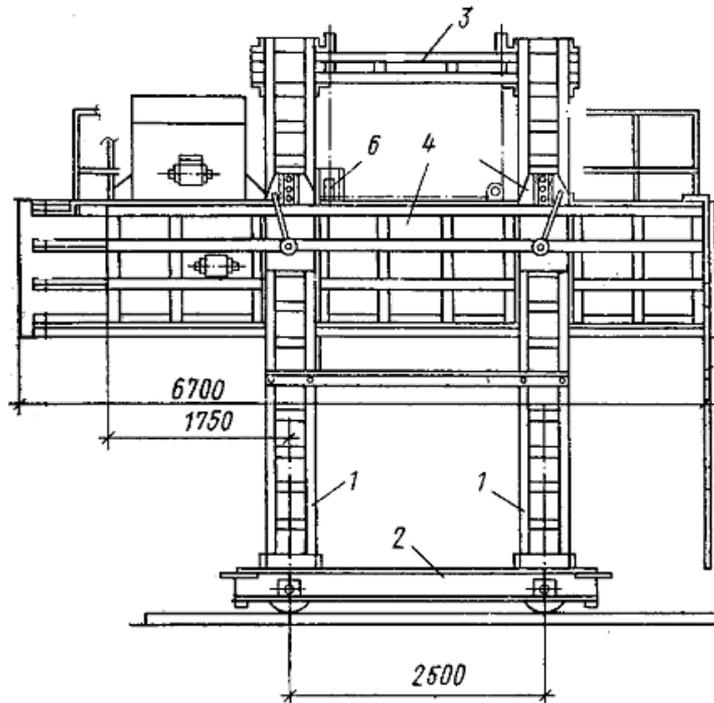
Горизонтально-перемещаемая опалубка: 1 – колонны портала; 2 – тележка; 3 – балка; 4 – щит опалубки; 5 – прижимное устройство; 6 – лебедка подъемника щитов
